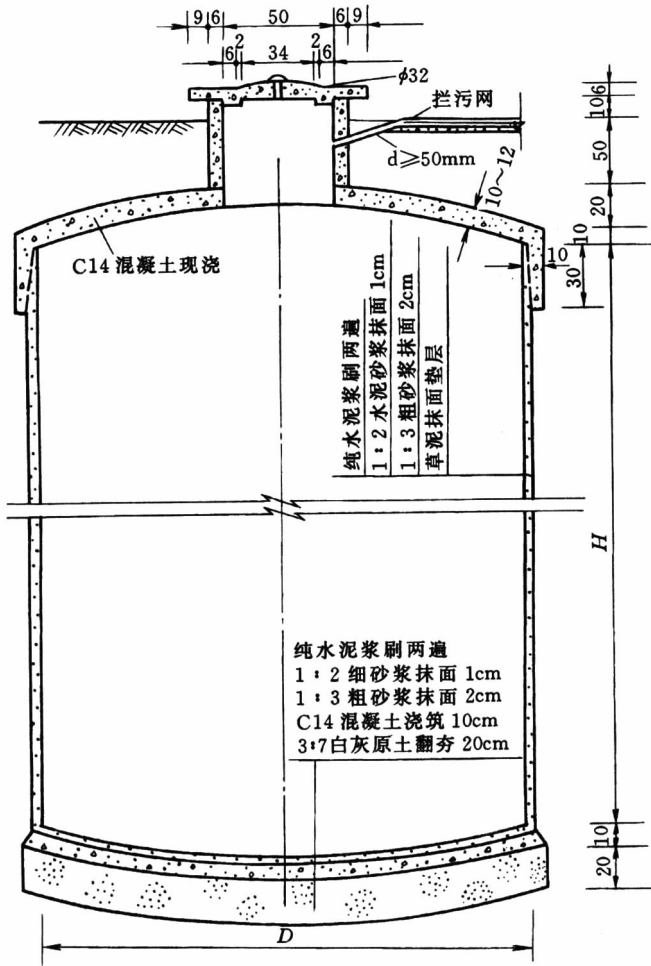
混凝土顶盖水泥砂浆抹面剖面图 (单位: cm)
